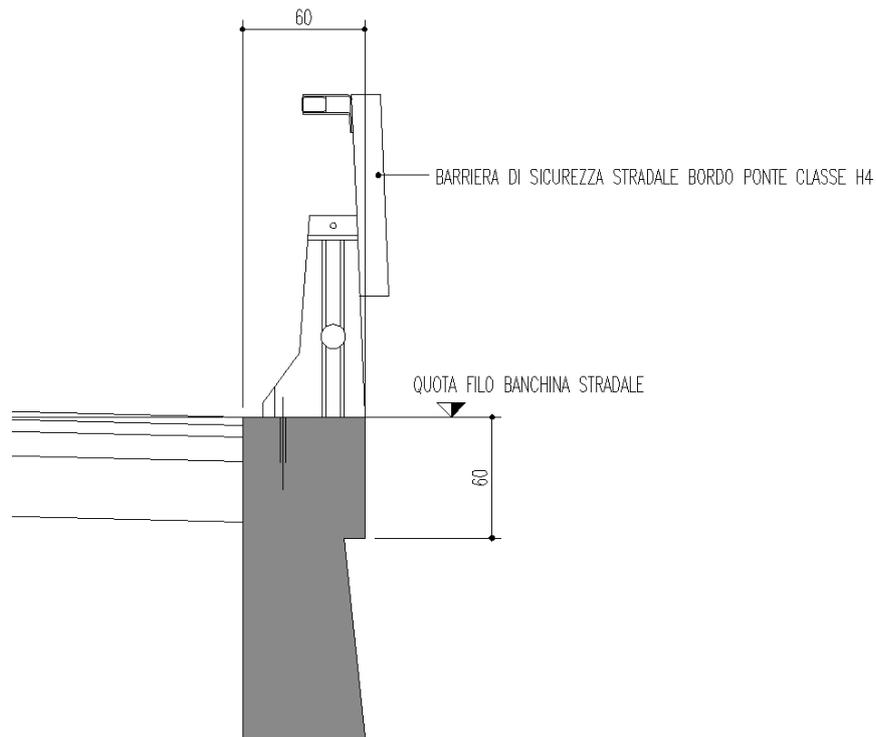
Sezione trasversale con testa muro tipo, cordolo in c.a. 60x60 cm e barriera di sicurezza stradale H4
